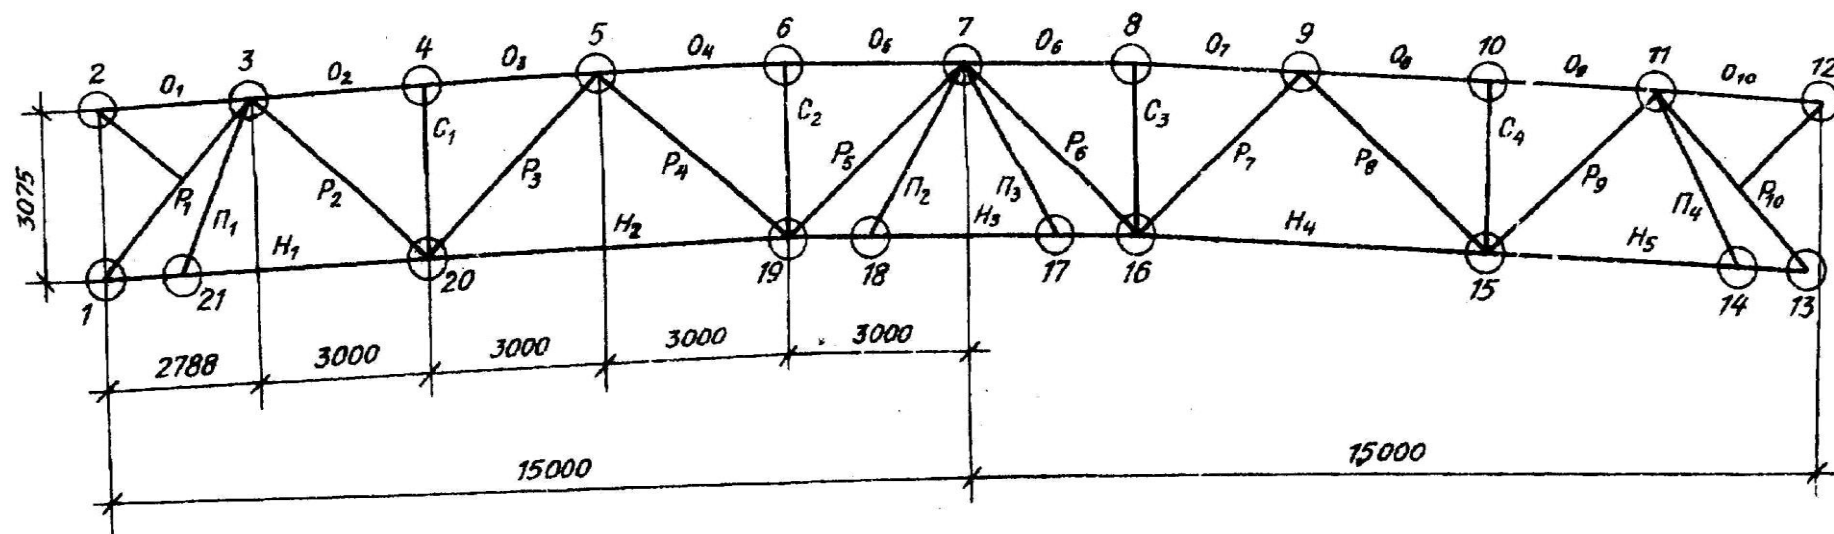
Геометрическая схема фермы IV – ФС 30 – 3, 15 В
